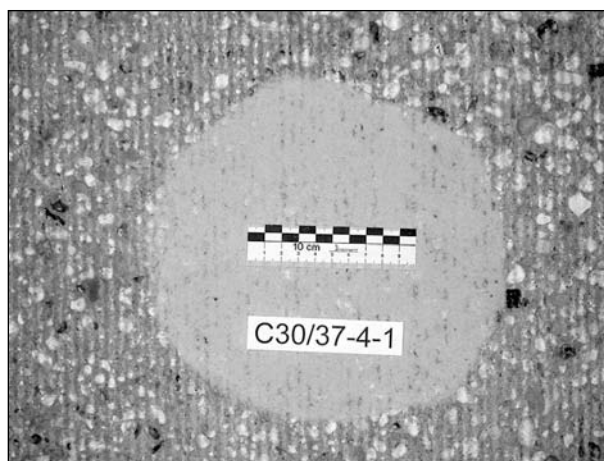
Rauheitsmessung auf Oberfläche mit großer Rautiefe (Beton C30/37 nach Walzenfräsen)
